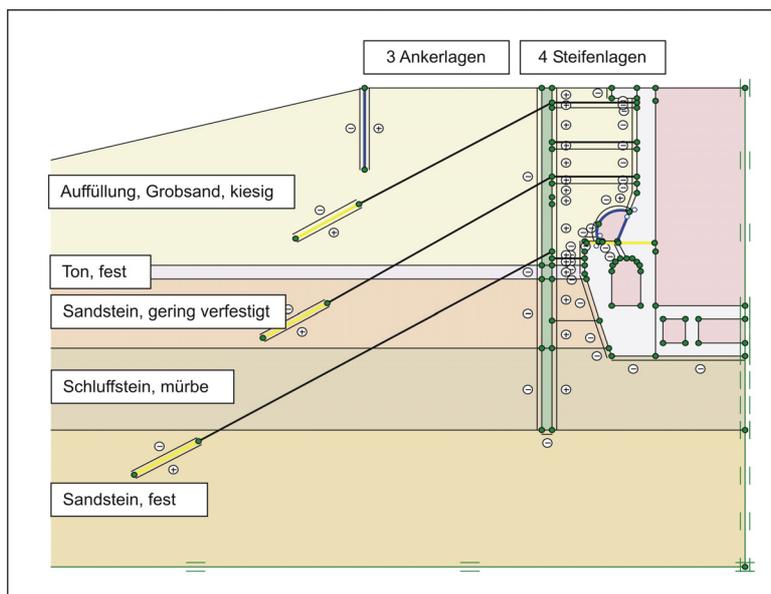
Berechnungsmodell Schleuse Bamberg mit Baugrubenkonstruktion und Baugrundaufbau
